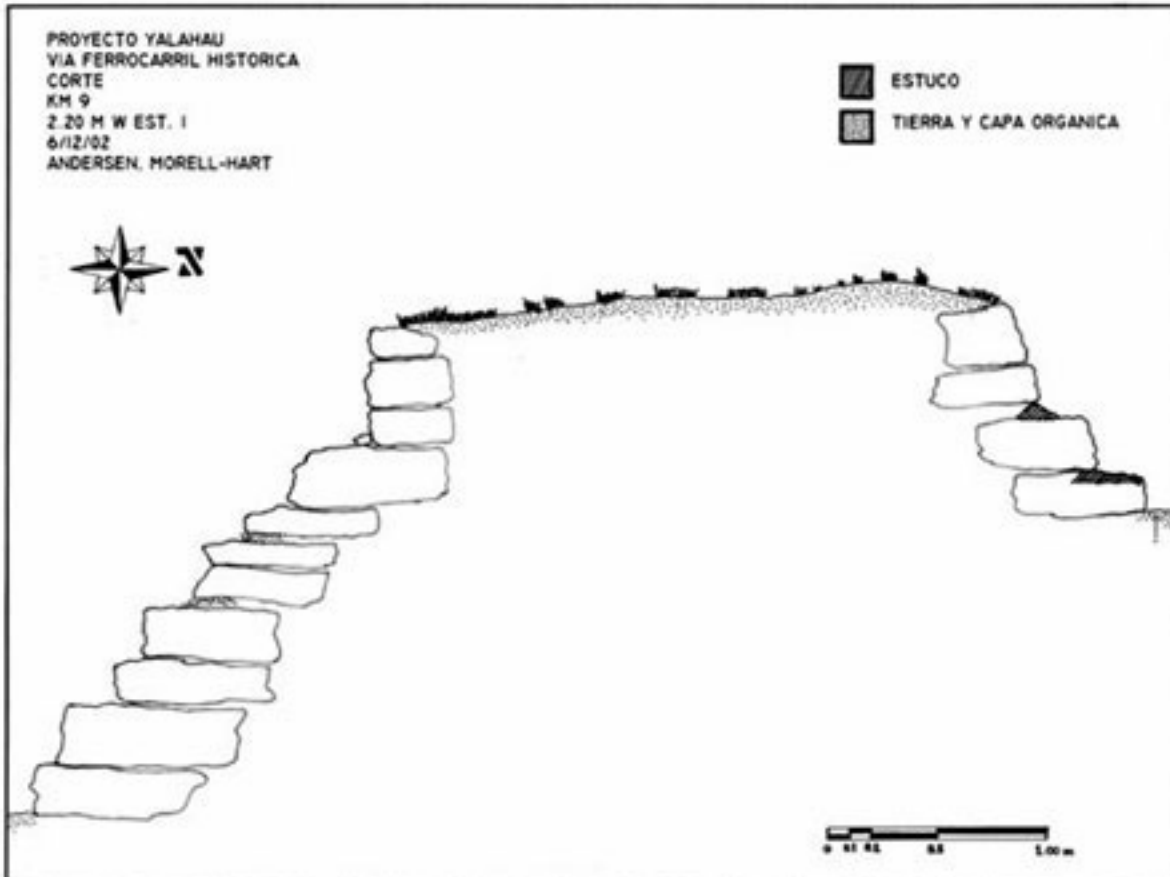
Corte transversal de Kilómetro 9 mostrando el estilo constructivo del lecho del camino. Dibujo de Bente Andersen y Shanti Morrell-Hart, 2002.
